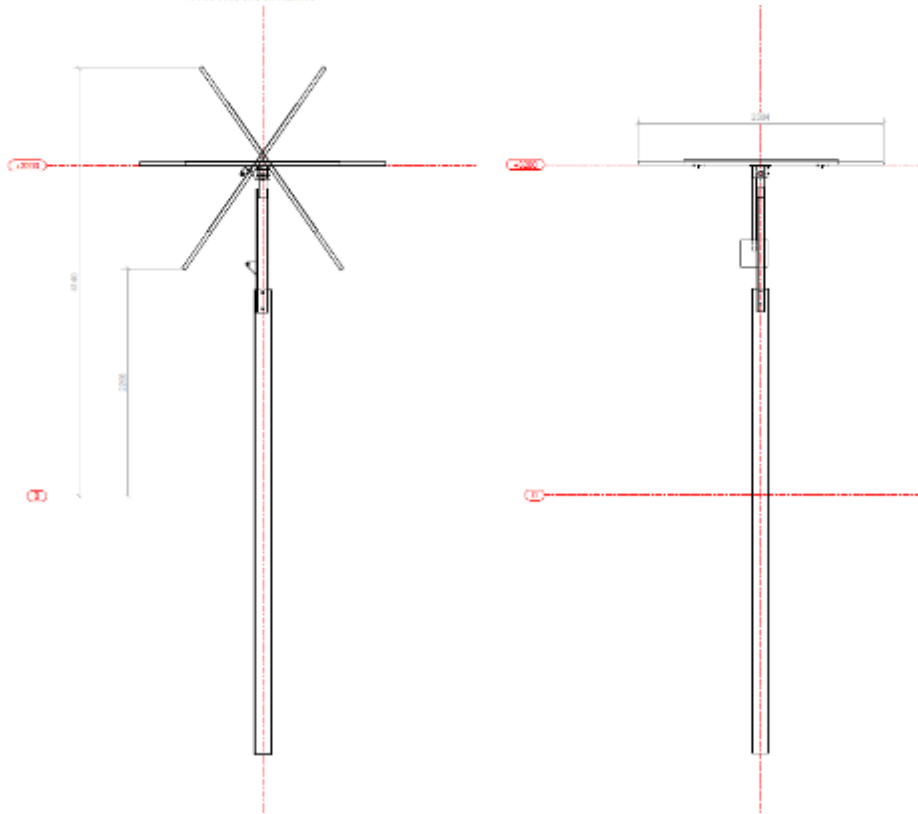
Esempio struttura sostegno moduli con palo di fondazione che raggiunge una profondità di 2 m. Altezza massima raggiunta 4,14 m
